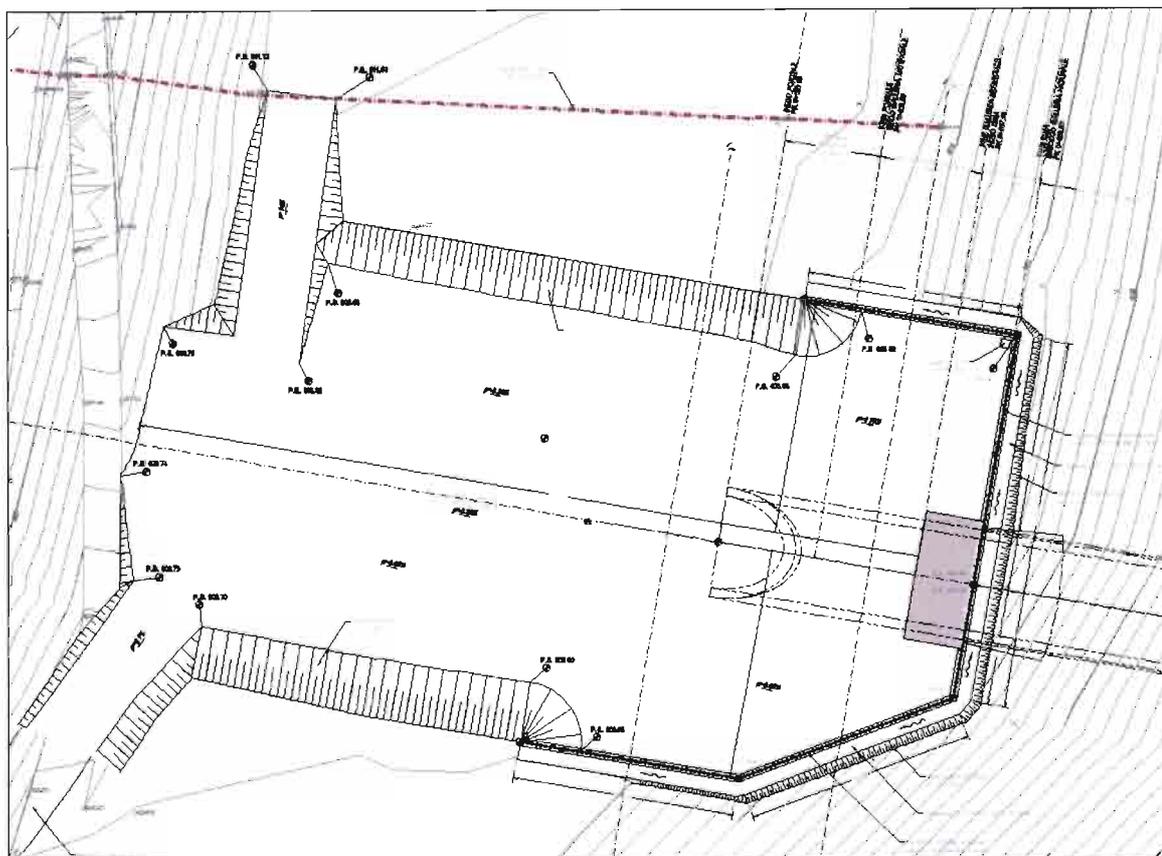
Stralcio planimetrico imbocco discenderia di Chiusa.
